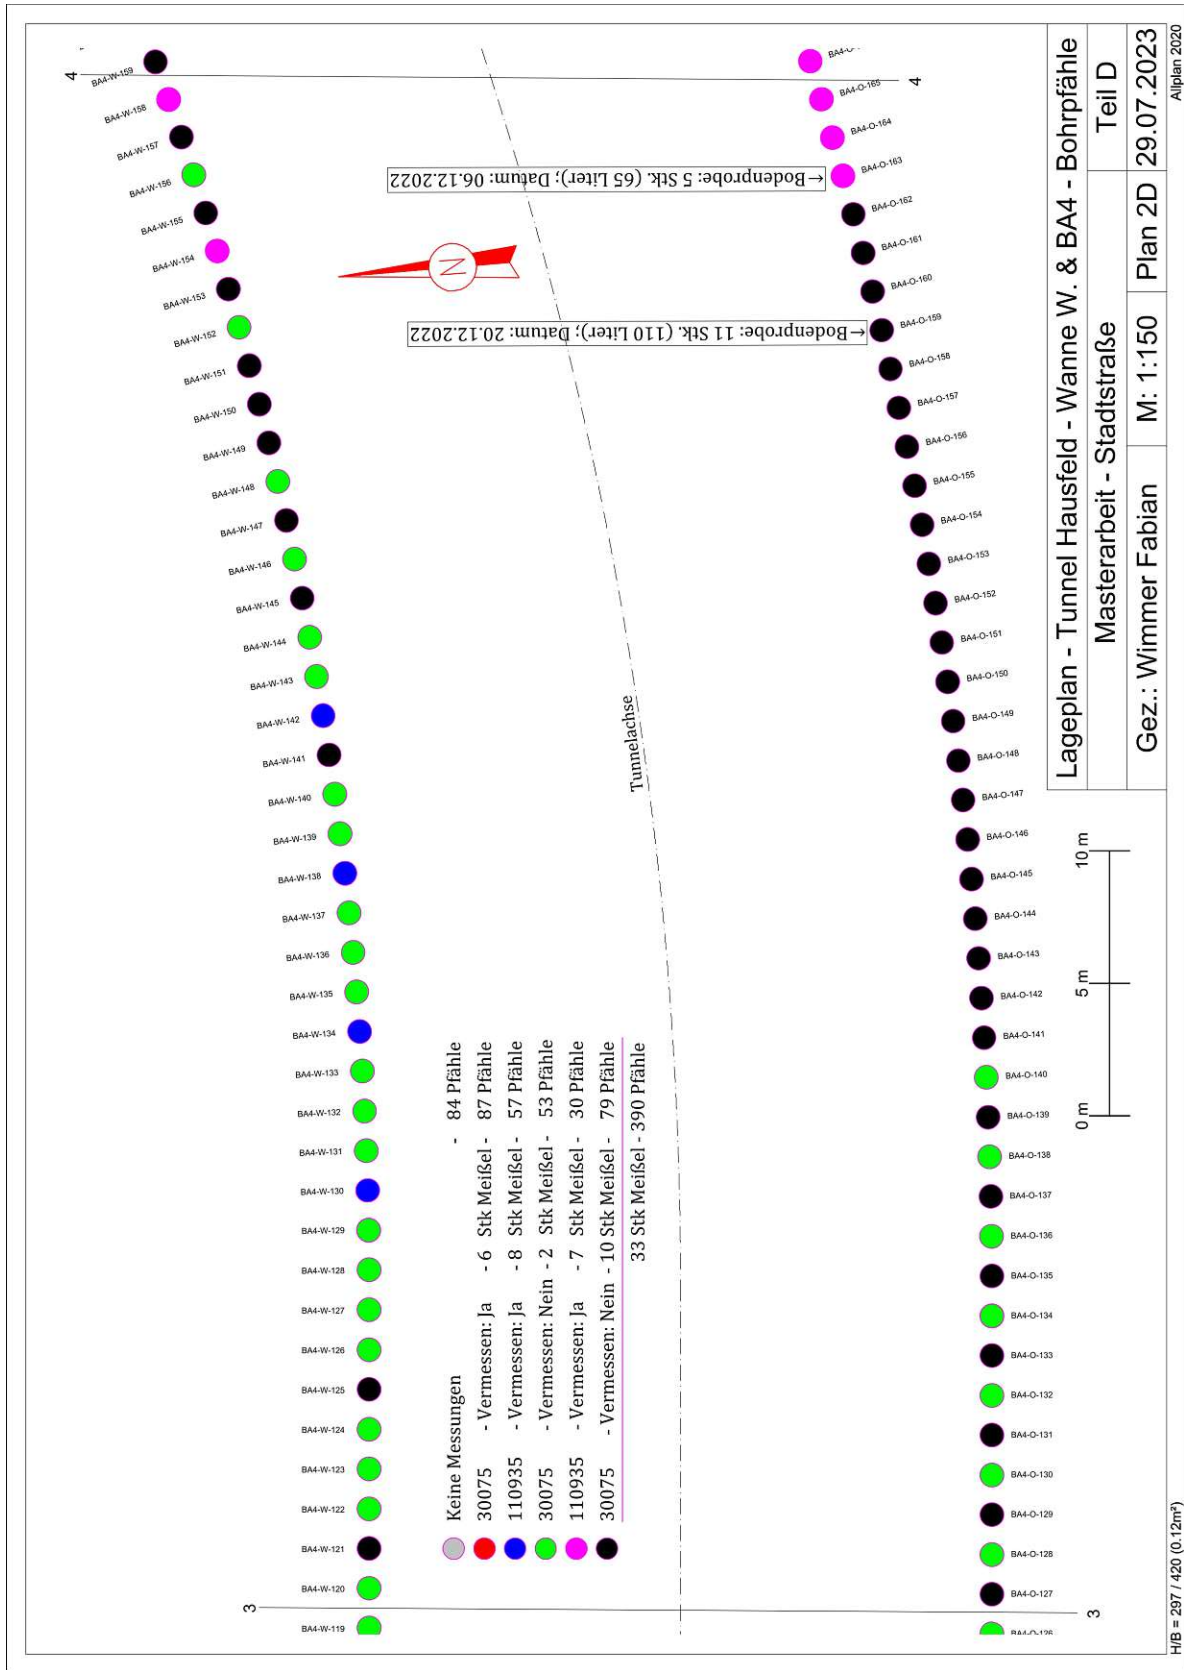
Lageplan - Tunnel Hausfeld, Wanne West und BA4 - Detailansicht Plan 2D; Plangrundlage [15]
